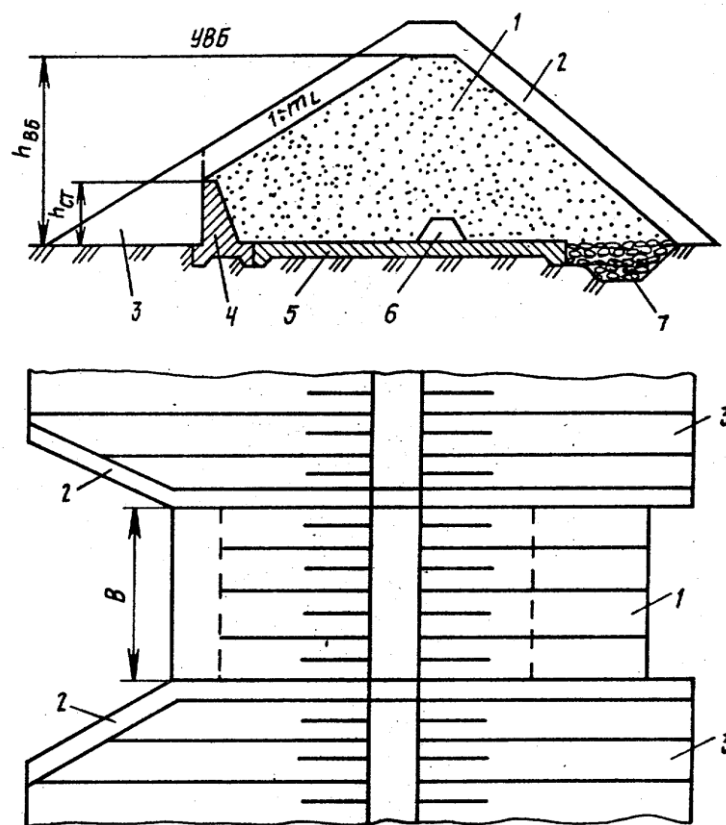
Водосброс с размываемой грунтовой пробкой
